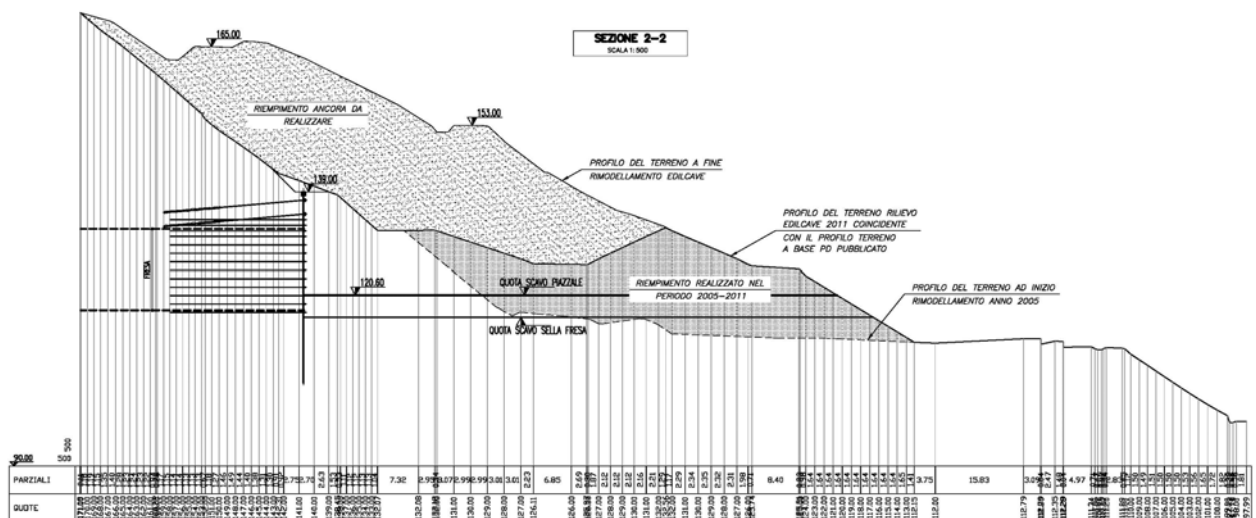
Sezione di confronto tra il riempimento rilevato e quello di progetto sulla nuova carreggiata autostradale della Gronda in direzione Est
